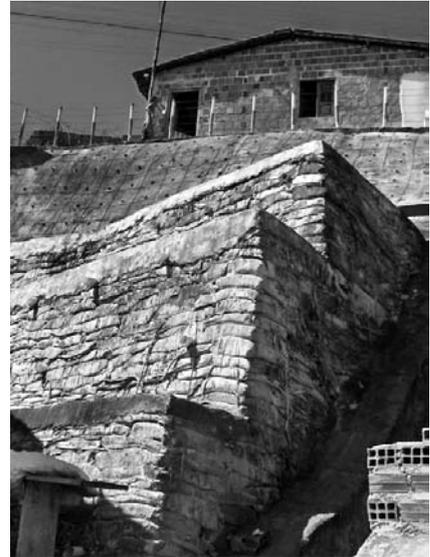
Muro de arrimo em solo-cimento ensacado. (Coutinho et al., 2005)
